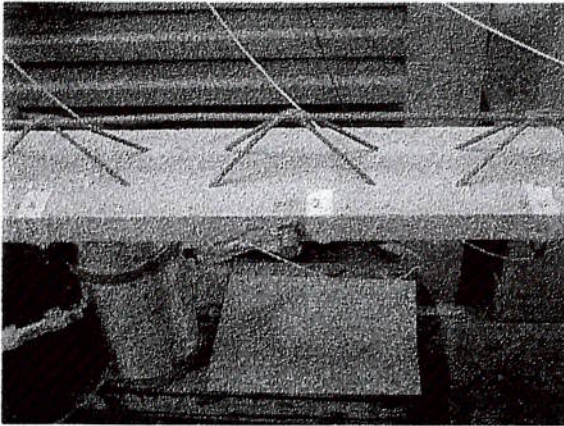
Vista parcial da viga com detalhes da armação da viga e dos acelerômetros .
